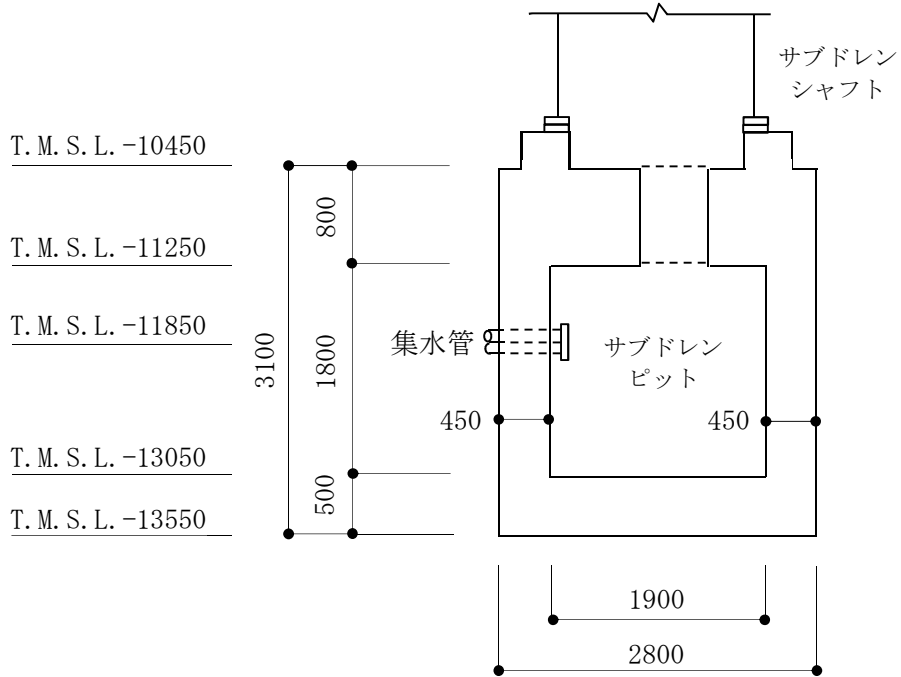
タービン建屋サブドレンピットの概略断面図 (B-B断面) (単位 : mm)
